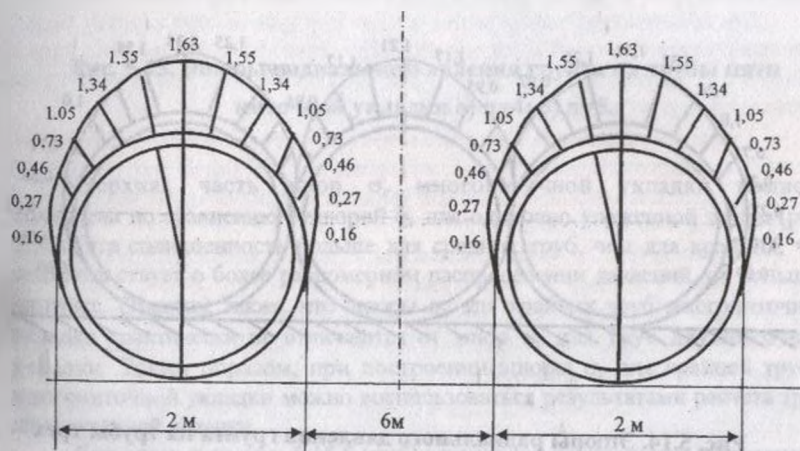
Эпюры радиального давления грунта на трубы двухниточной укладки.
